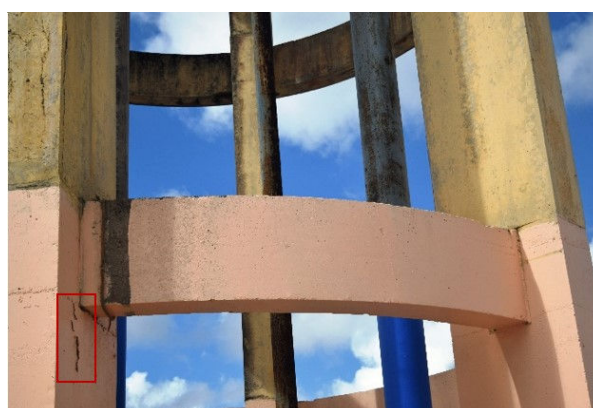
Vista do 1º nível de viga e 1º lance de pilar, em destaque a ocorrência de trincas no pilar
